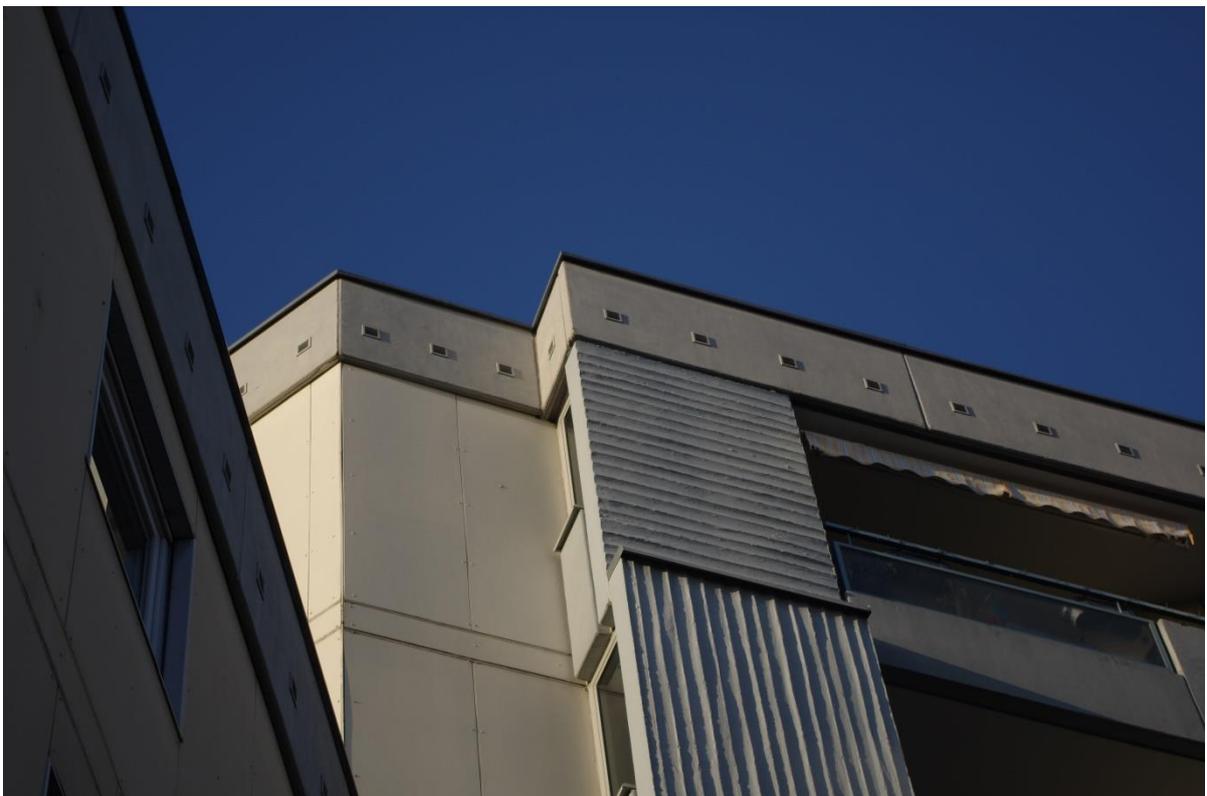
Balkone mit Zierelementen sowie Blechattika im Dachbereich
